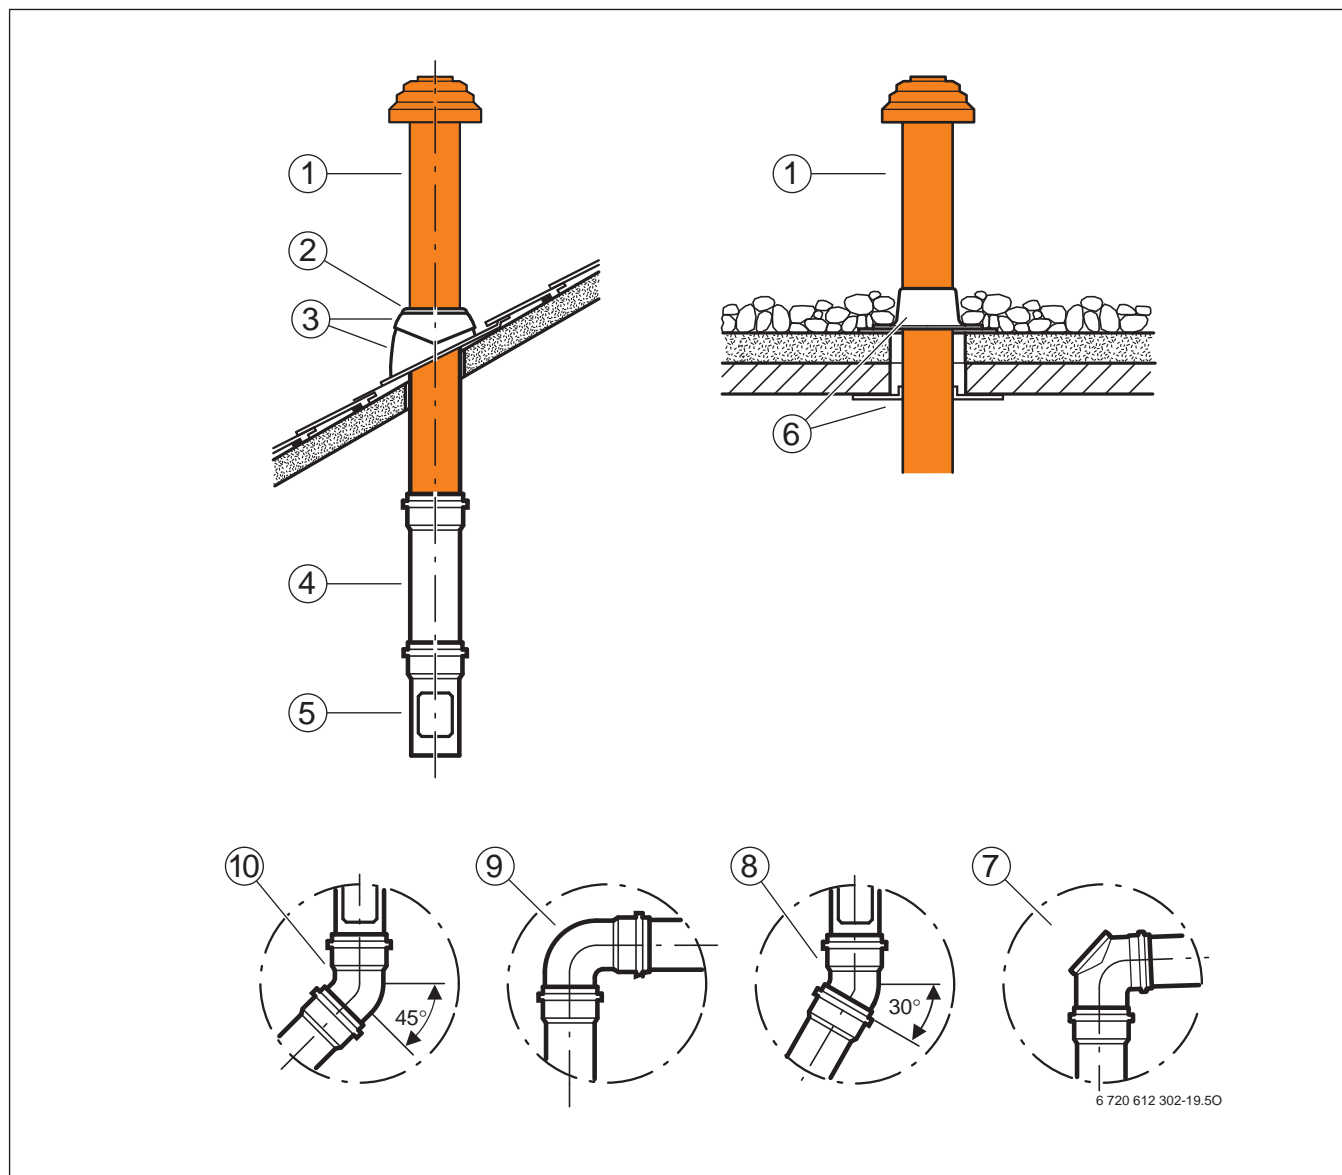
Abgasführung senkrecht Ø 80/125 mm über Dach (C<sub>33x</sub>)
